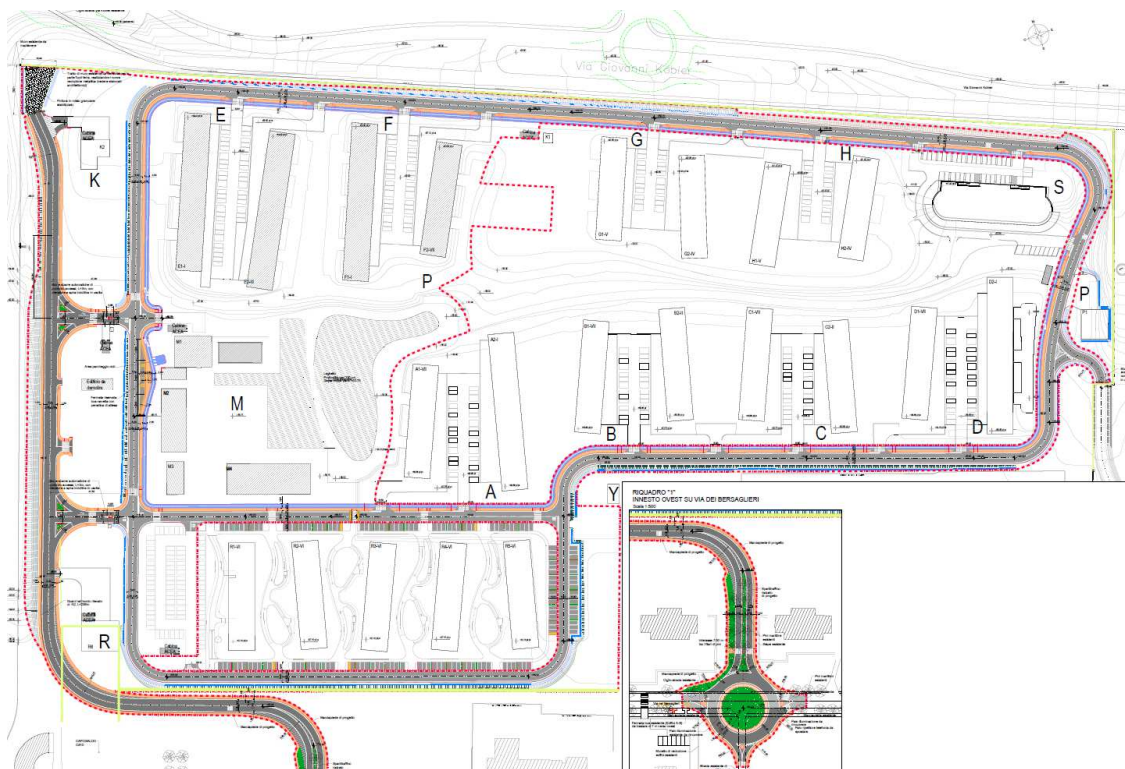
Key plan e Planimetria generale di progetto con individuazione del limite di Lotto 1
